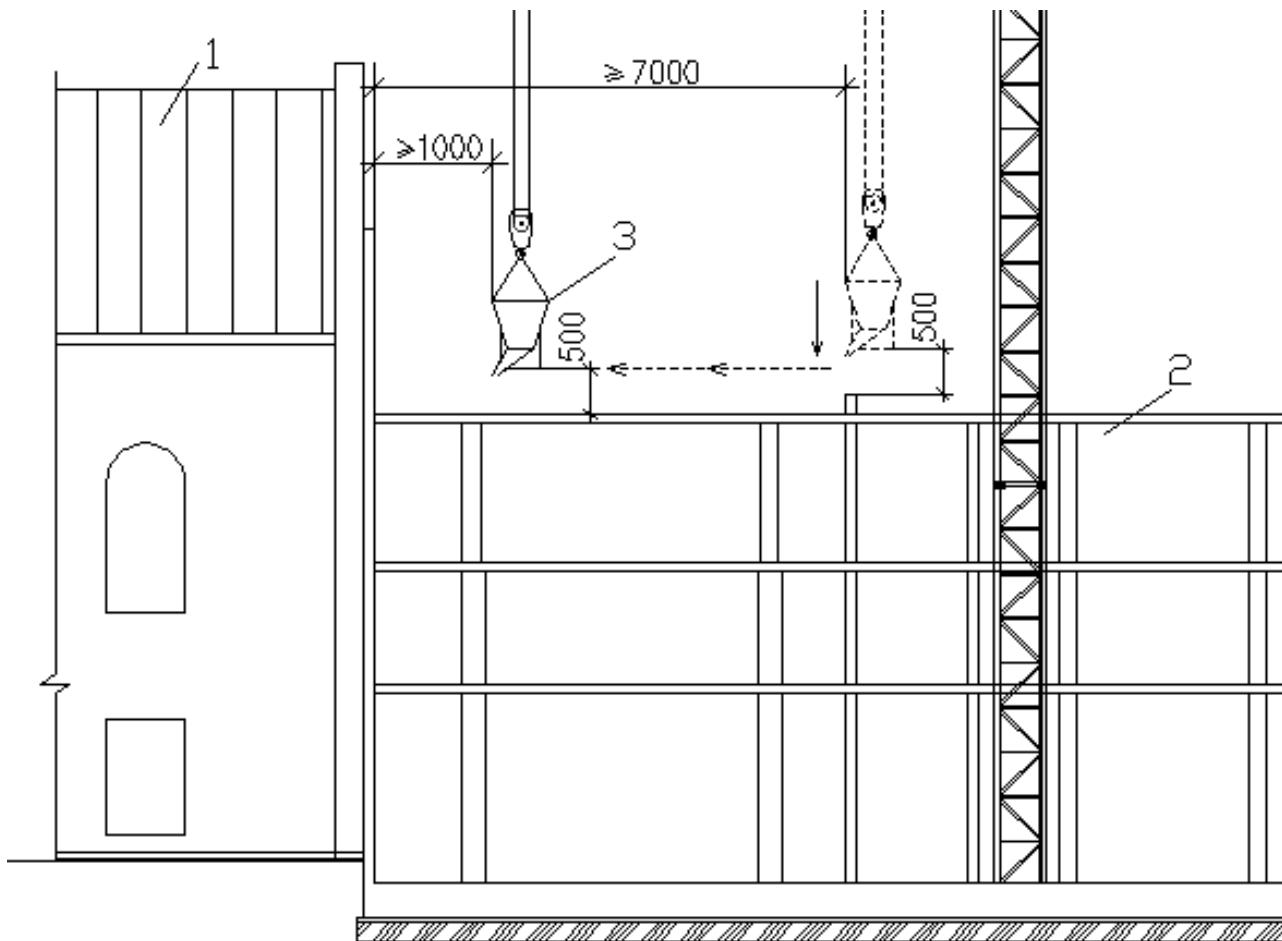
Схема подання краном бадді з бетонною сумішшю
